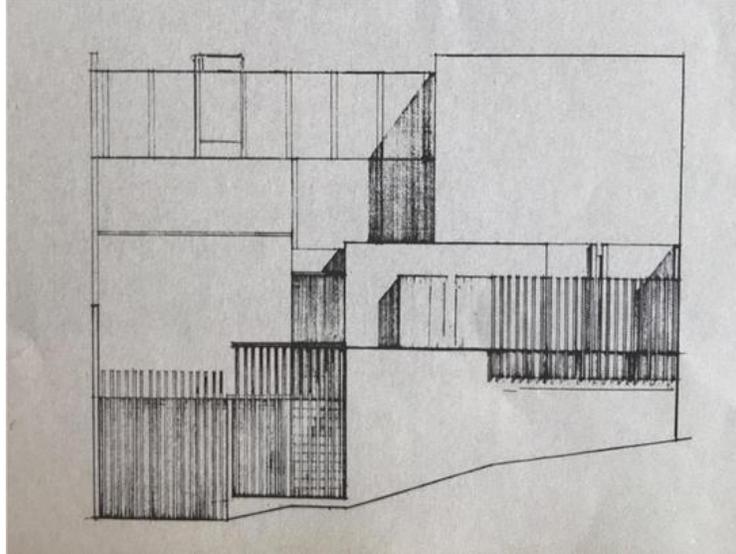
Vivienda Castrillón, Tecamachalco, 1965. Proyección de la fachada donde se advierte el terreno en desnivel, así como el juego de volúmenes. Fuente: AAM, FCM.
